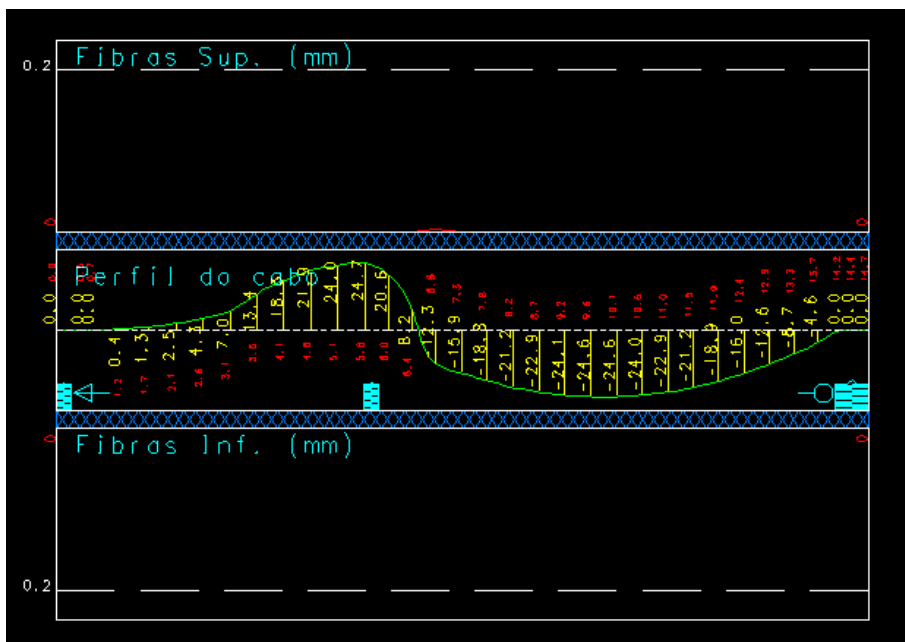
Fissuração viga V12 do 2º pavimento (CAD/TQS)
